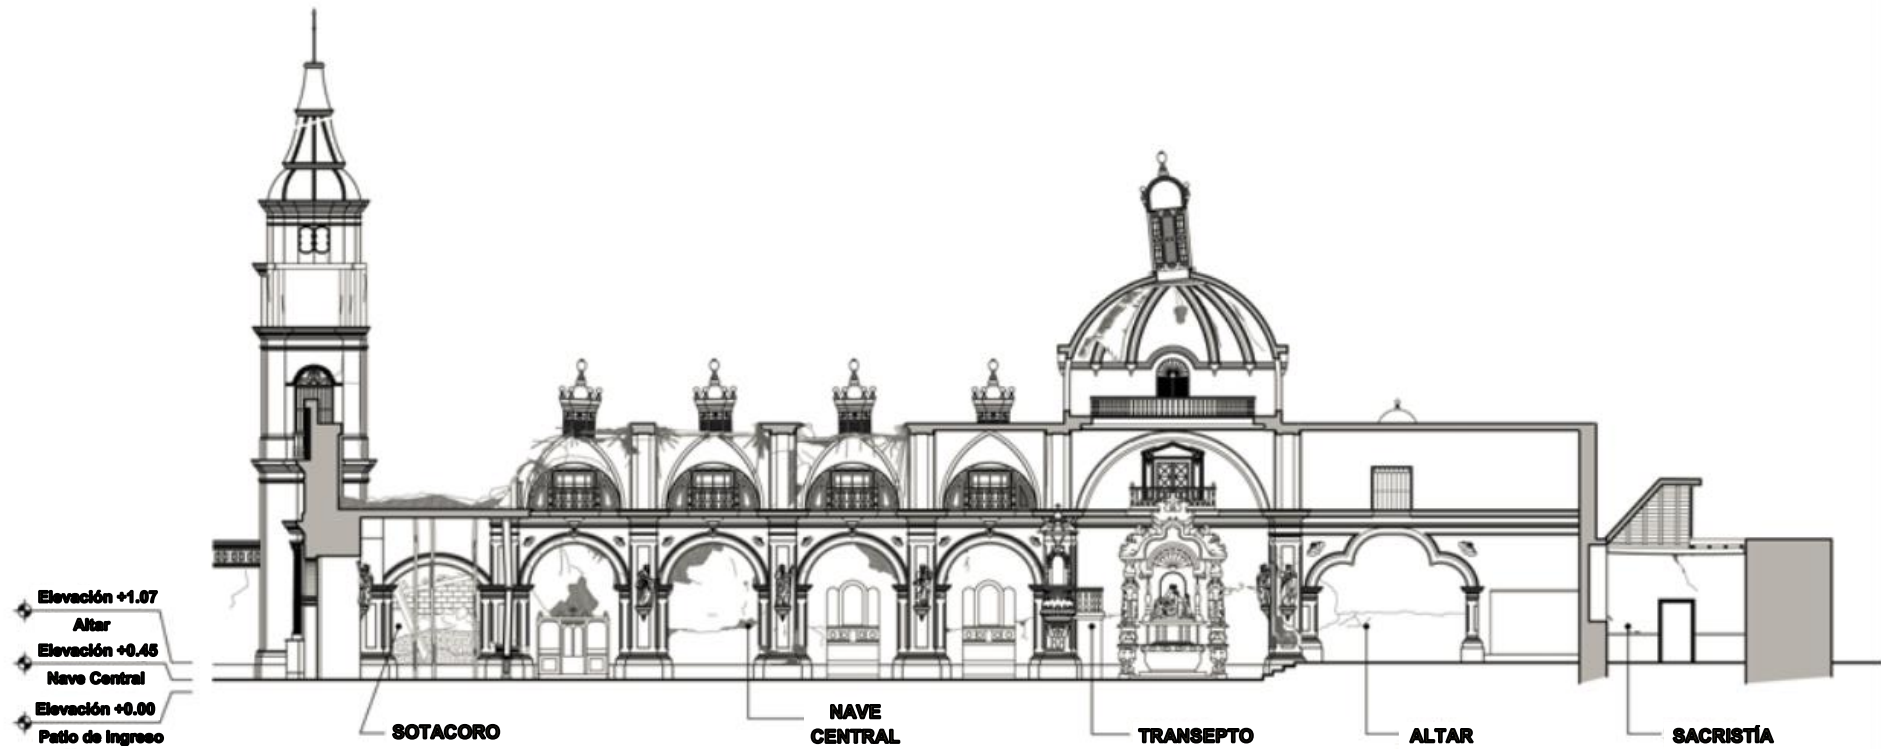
Disposición de la Catedral – Vista de corte [1]
